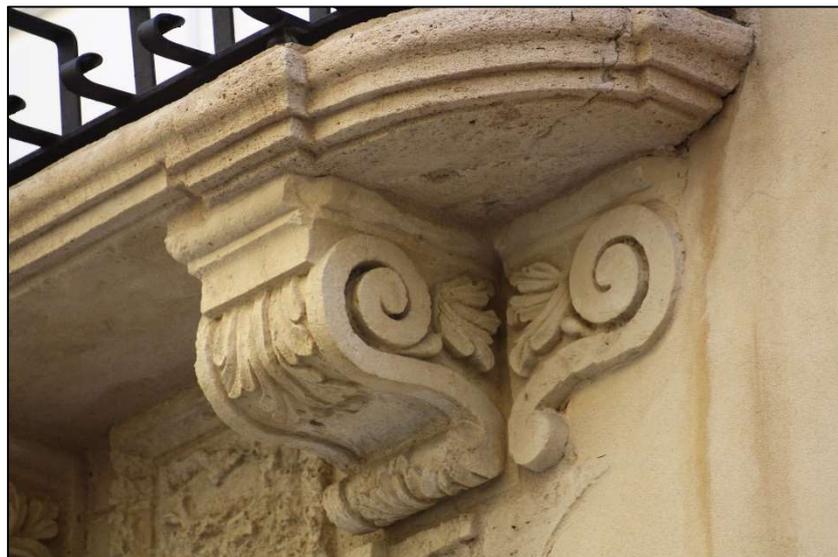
Mensola del balcone laterale (foto dell'autore)
